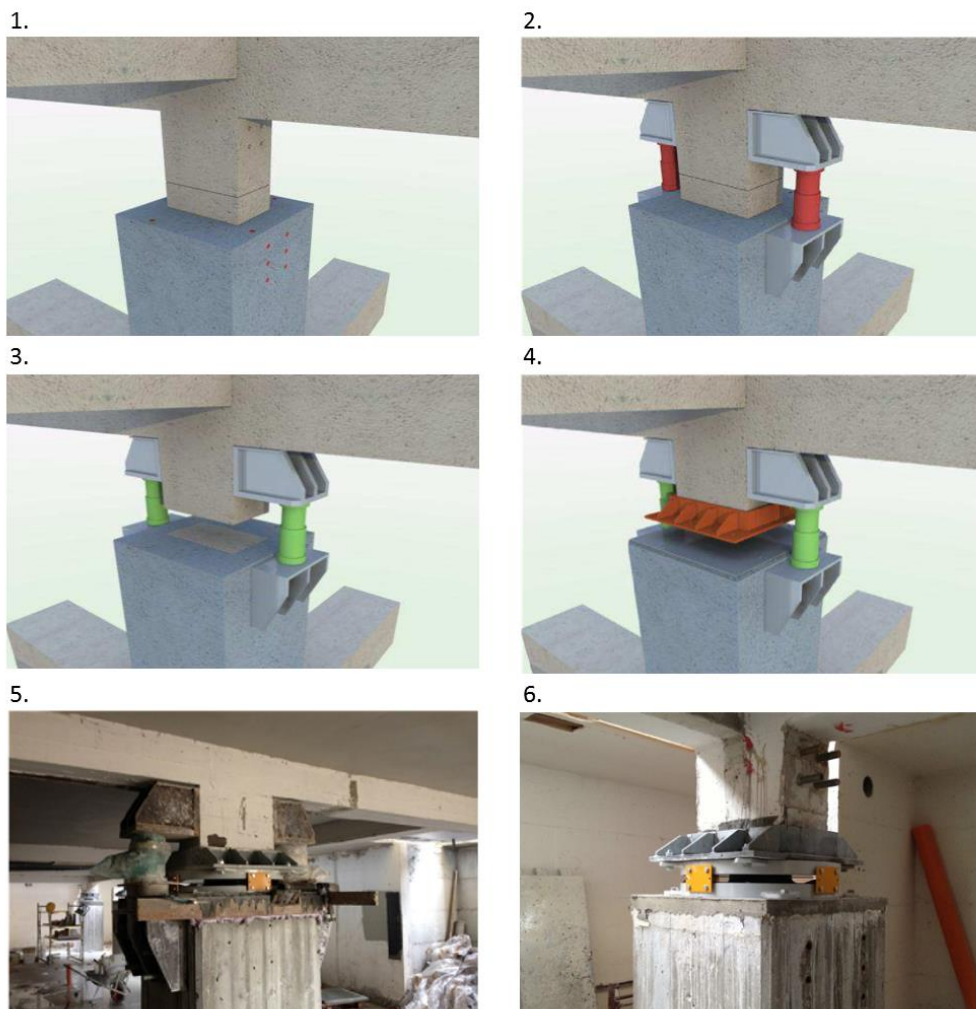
Procedimento de instalação de isoladores em colunas de betão armado (adaptado de Luca Trombetta et al, 2014)
